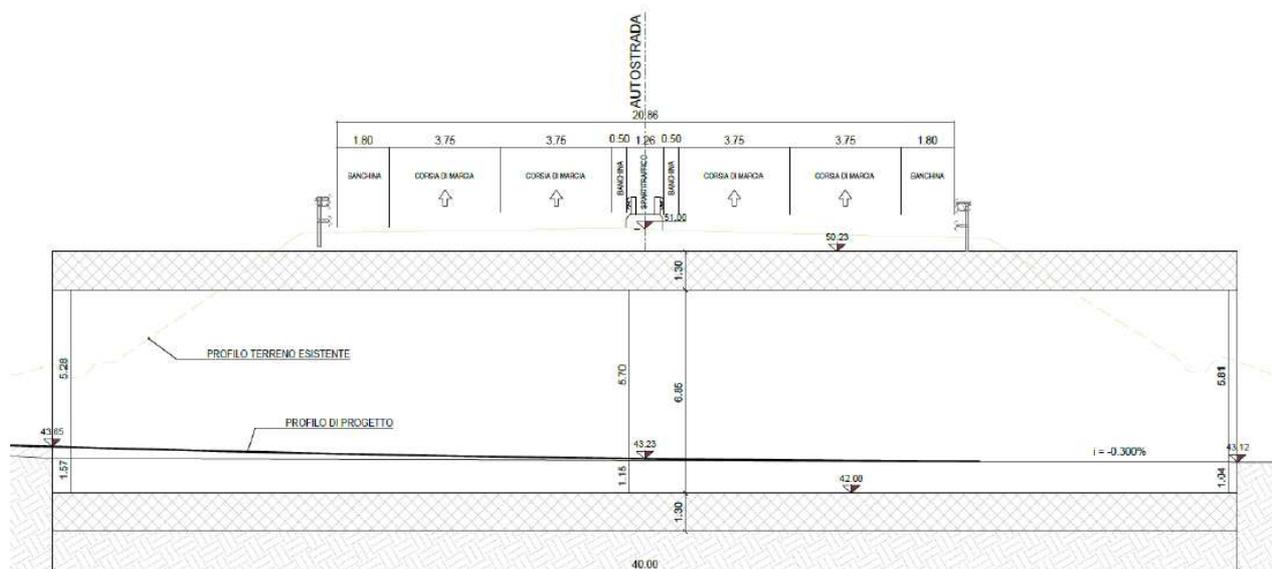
Sottovia A14 – Profilo longitudinale (Soluzione 1)
